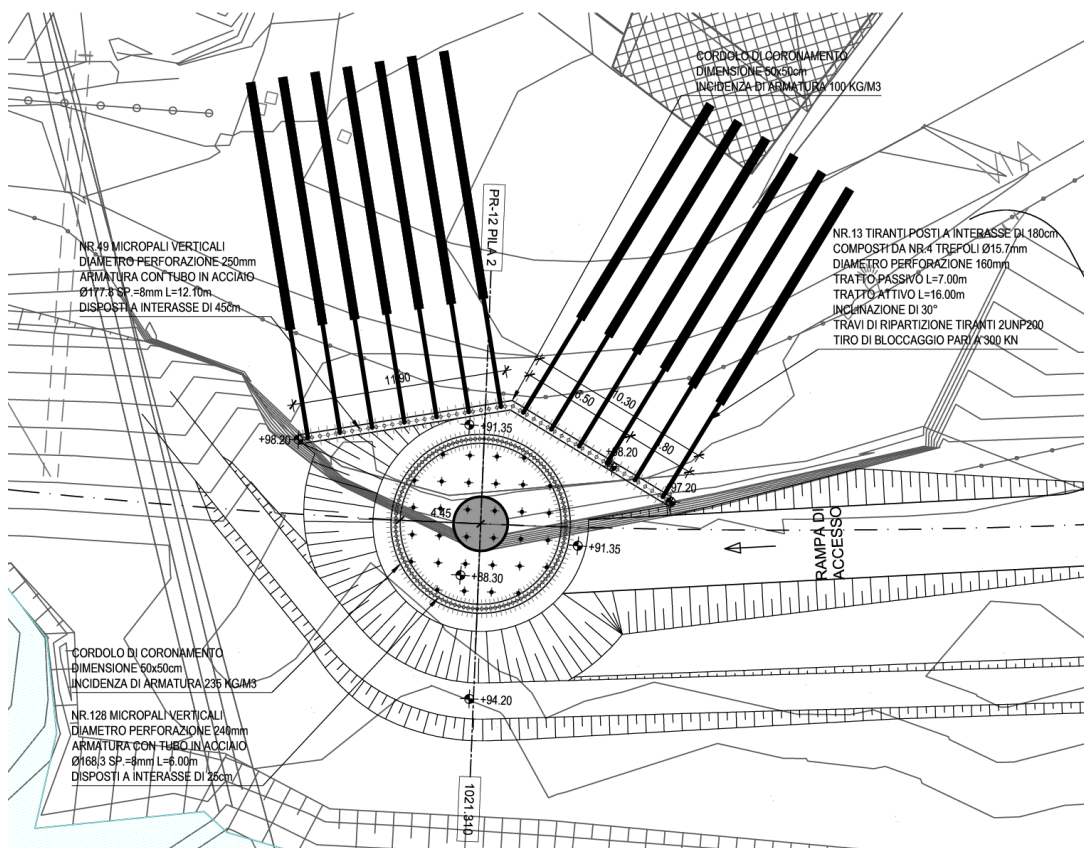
Stralcio planimetrico opere provvisoriale e definitiva pila 2.
